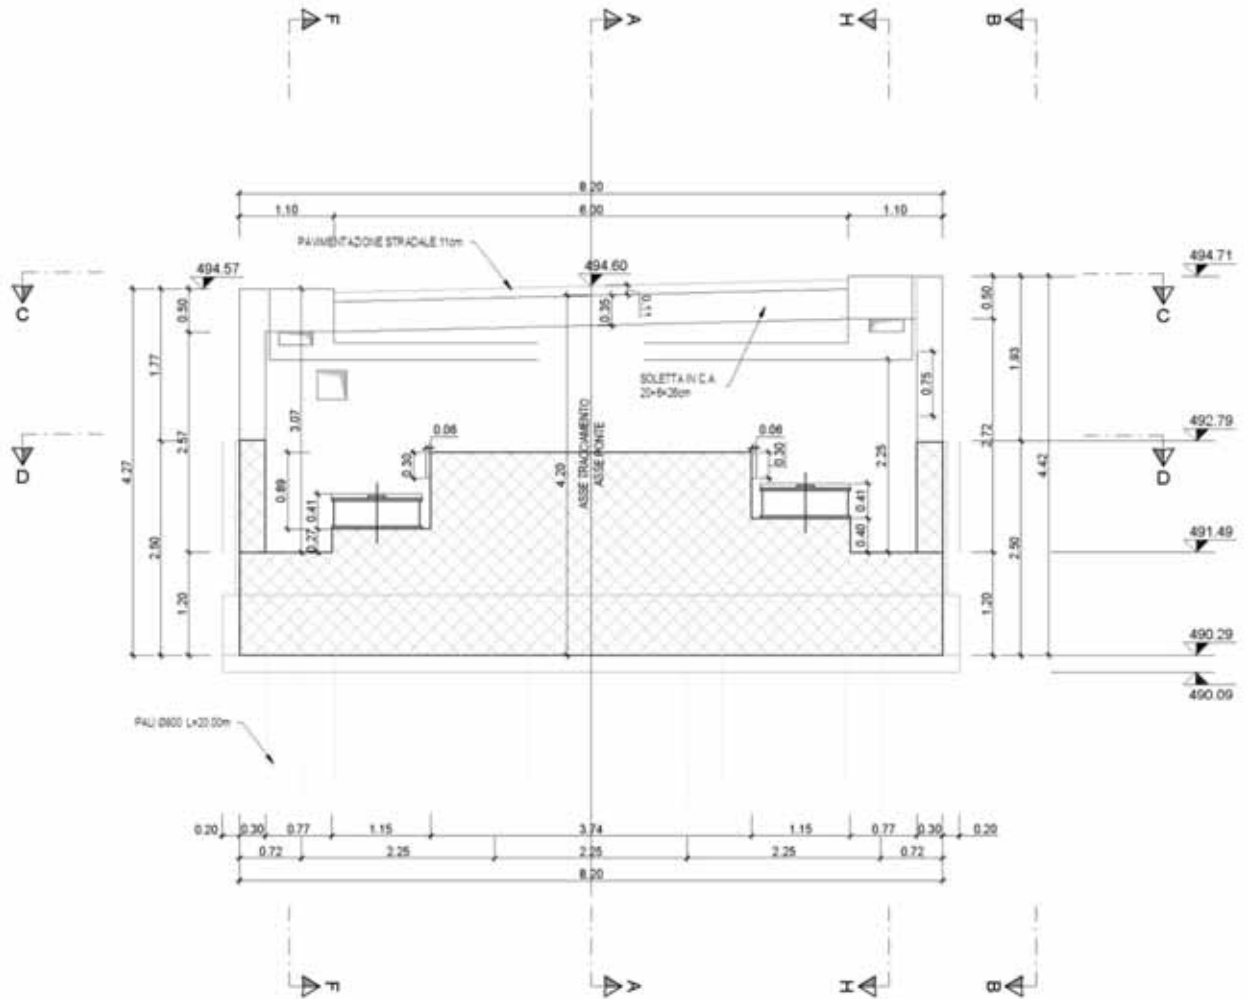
SPALLA A – Sezione longitudinale
